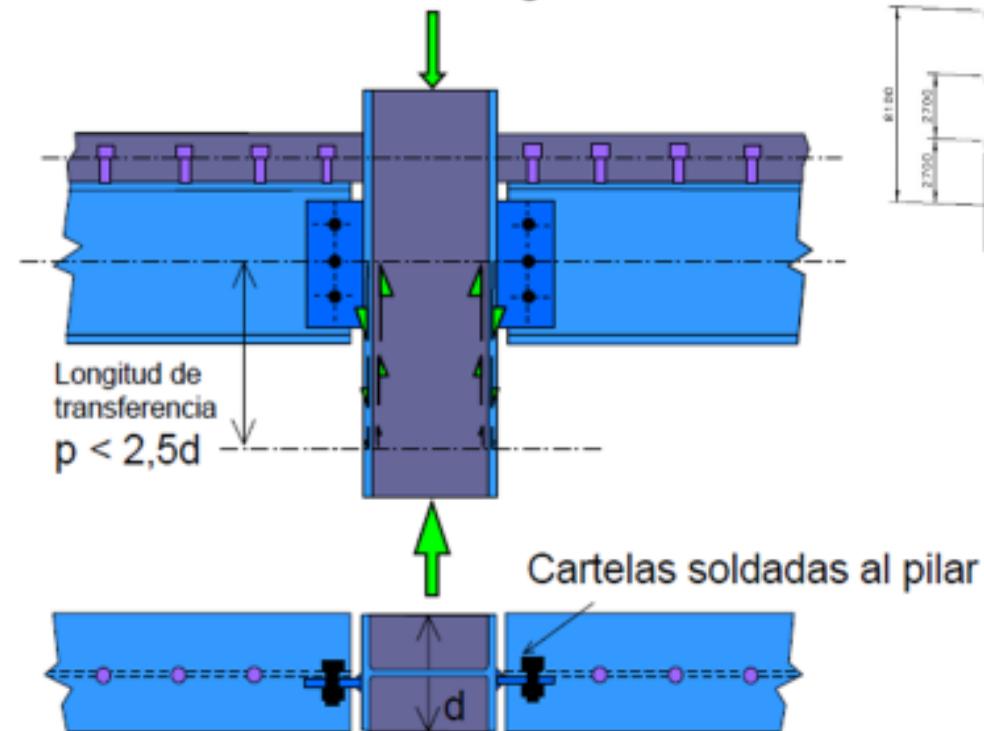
Diagrama de columnas mixtas vistas en detalles.
